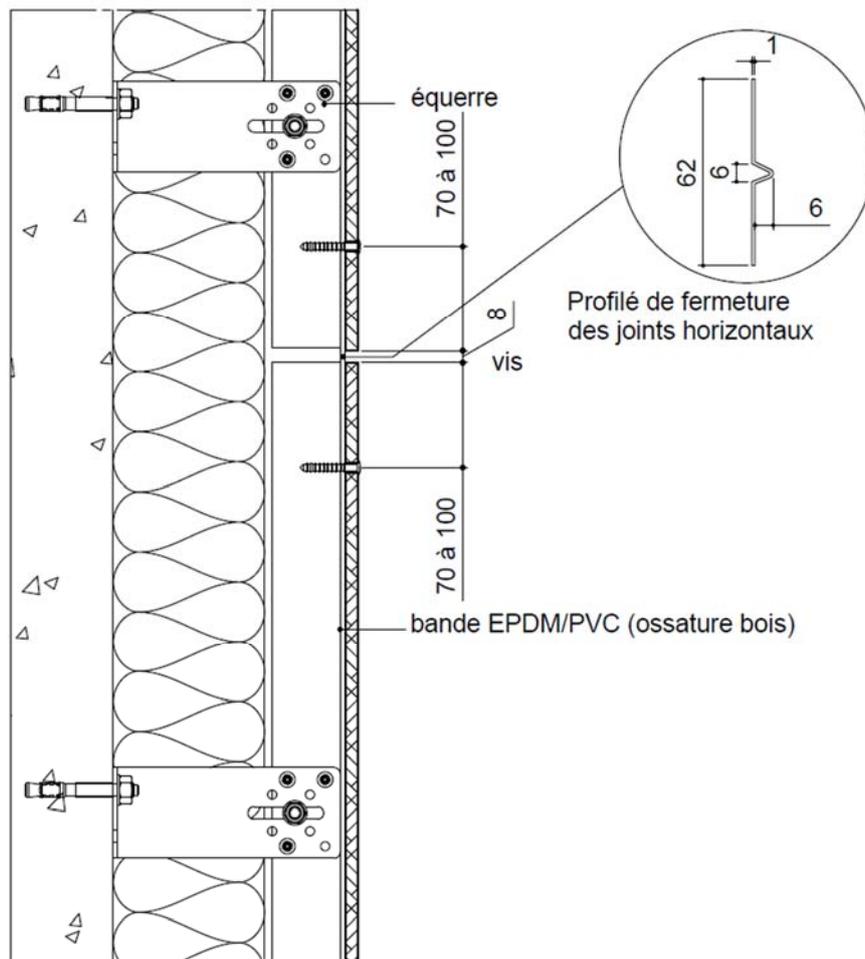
Joint horizontal (coupe verticale) sur ossature bois pour des longueurs $\leq 5,40$ m ou ≤ 3 m sur aluminium et ≤ 6 m sur acier (cote en mm)
